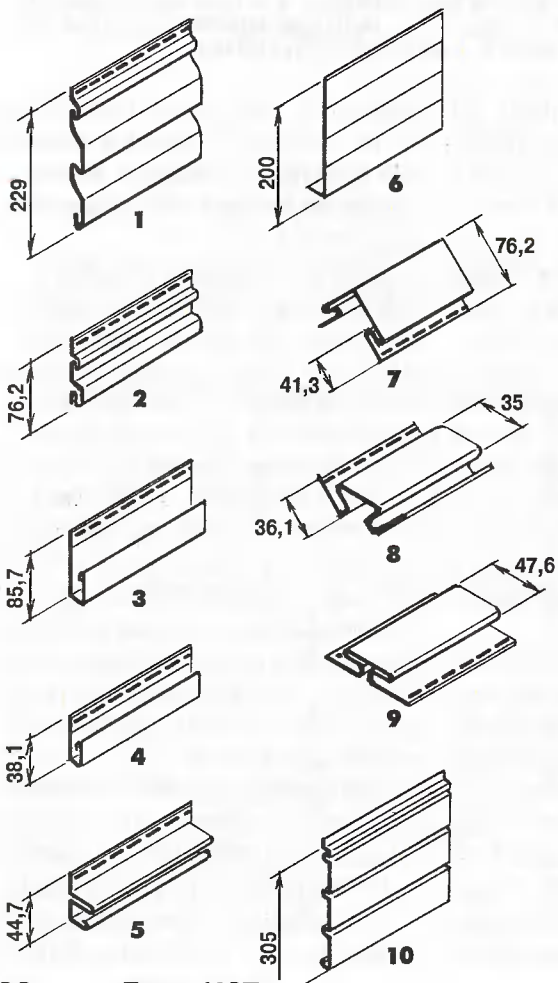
Элементы сайдинговой отделки наружных стен строений:
